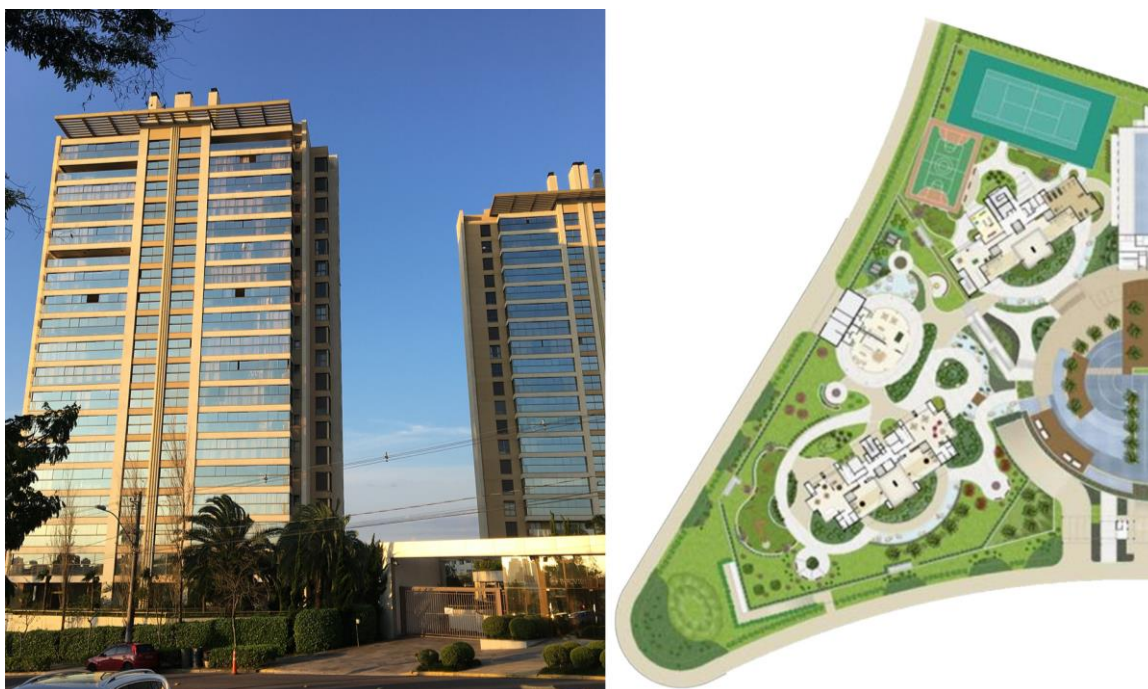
Parc Vienne, projeto da STA Arquitetura (Ano 2011).
